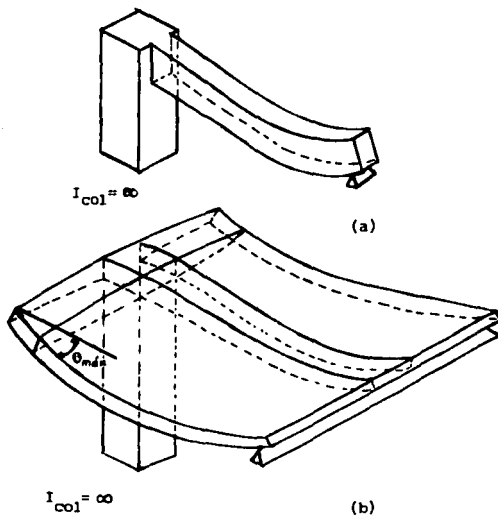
Deformaciones en una viga y en una losa plana de crujeas de orilla.
